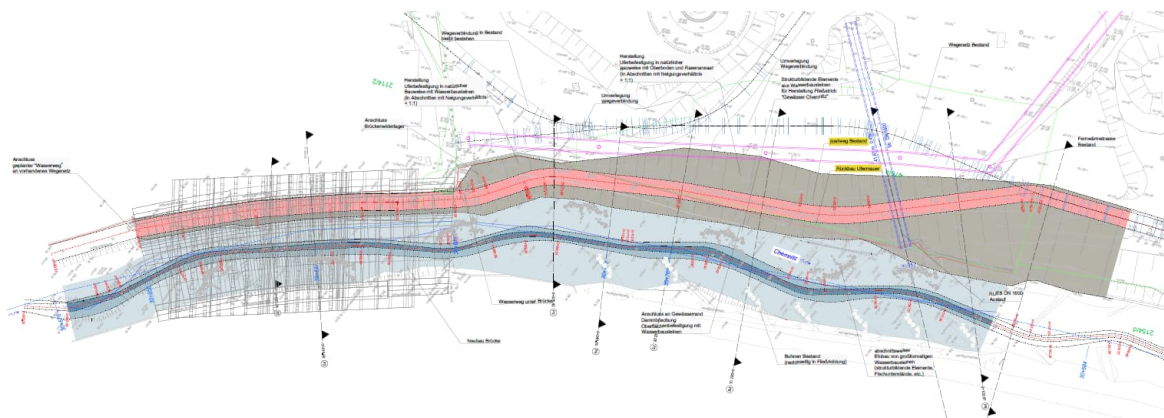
Lageplan „Neubau Wasserweg am Falkeplatz“ – BTP Vorplanung; Stand 11.2023⁴⁰
